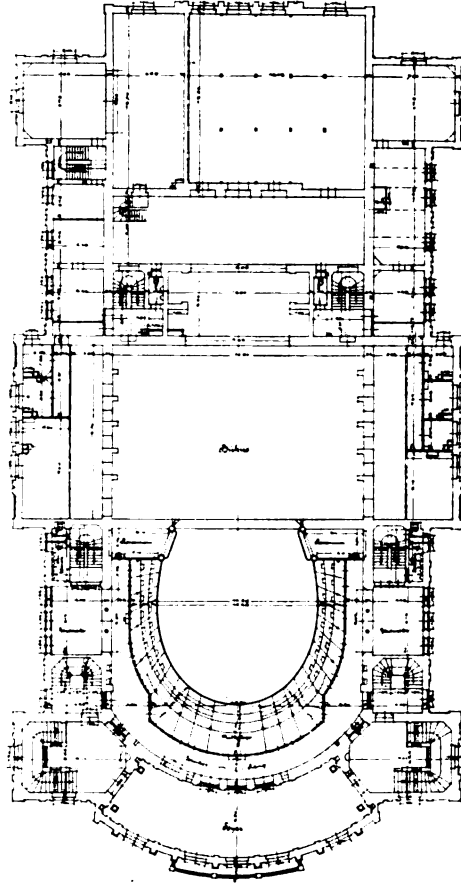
Grundriss des 1. Rangs. 1:740.
